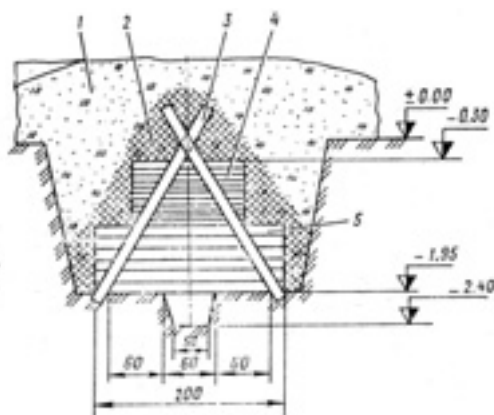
Быстровозводимое убежище на 15 чел. из железобетонных перемычек: 1 – насыпной грунт; 2 – утрамбованный грунт; 3 – перемычка 1ПРЗ-24.12.14; 4 – перемычка 1ПР1-12.12.6; 5 – перемычка 1ПР3019.12.14
